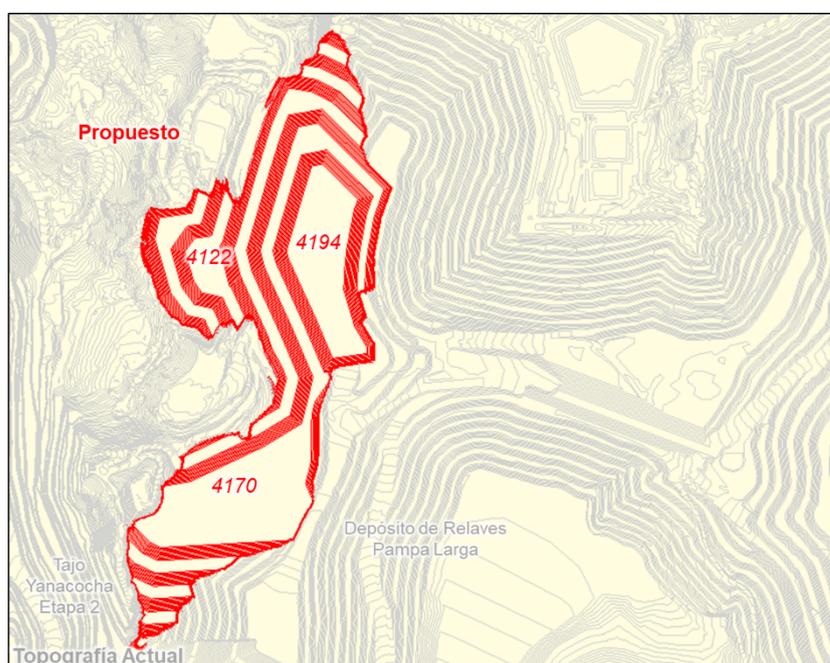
Plan de descarga del Depósito de Desmonte Mirador – Año 2024 – Vista en planta
